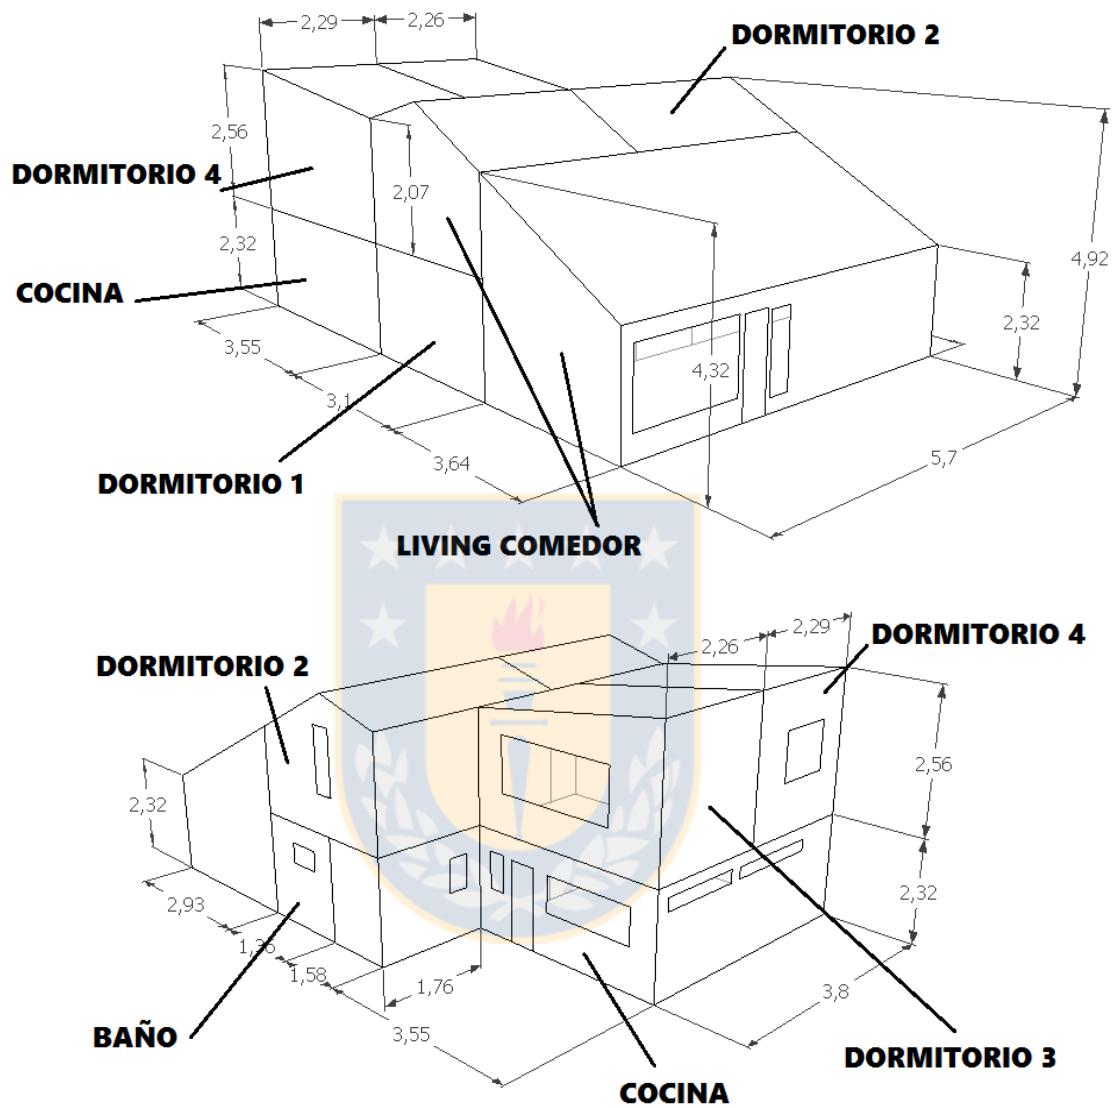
Esquema vivienda 2. *Arriba*, fachada frontal. *Abajo*, fachada posterior
